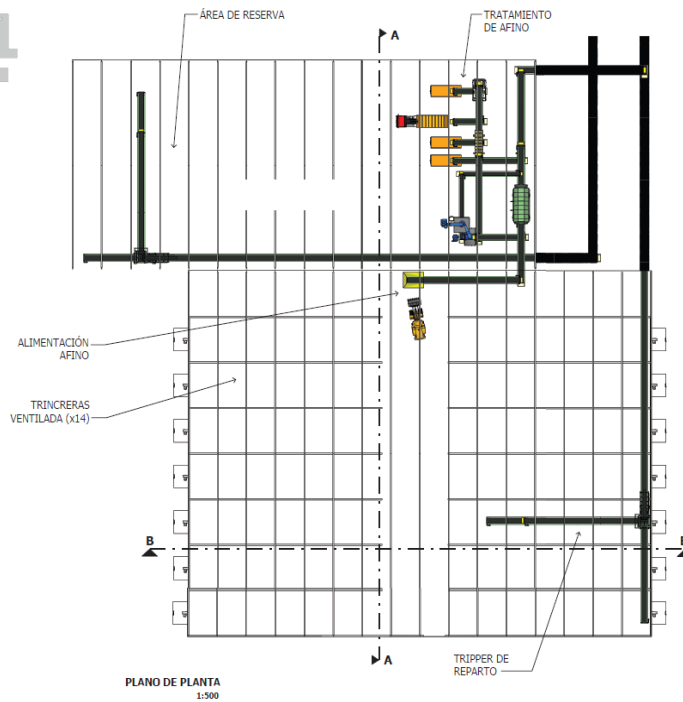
Planos de la planta de biosecado y afino: equipos propuestos
